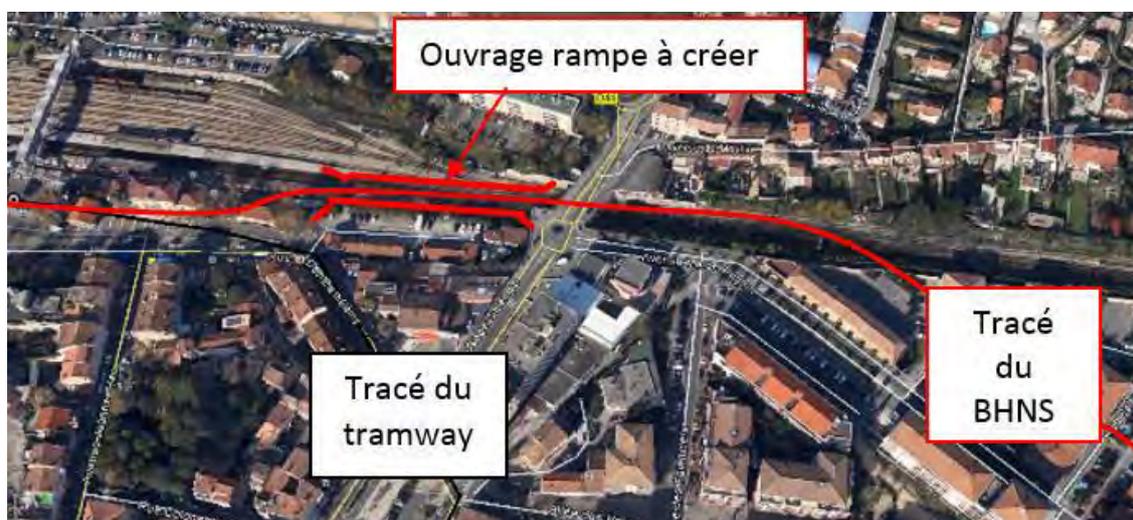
Rampe au niveau du barreau routier à créer sur Aubagne
